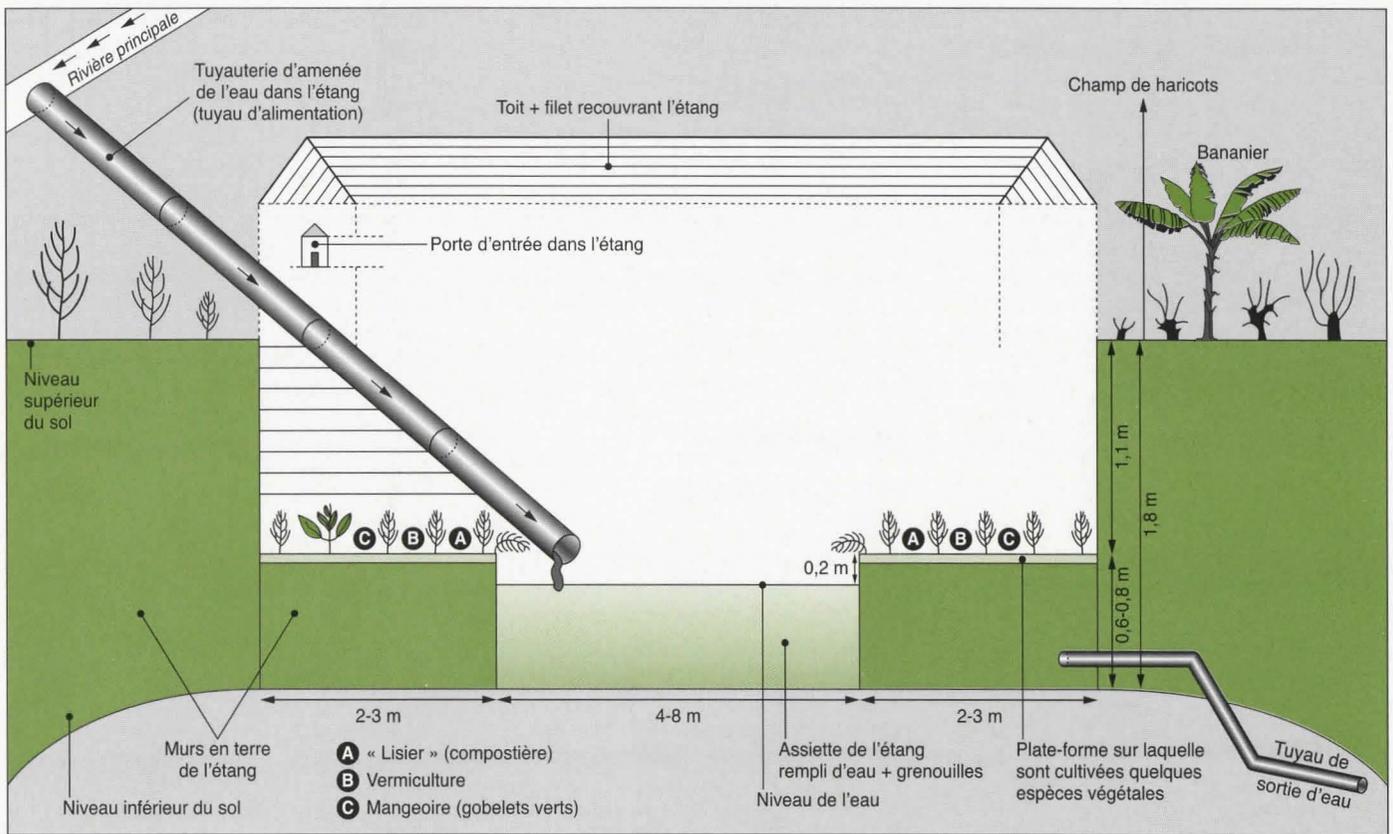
Coupe-type d'un étang creusé dans le sol du site d'essai.
